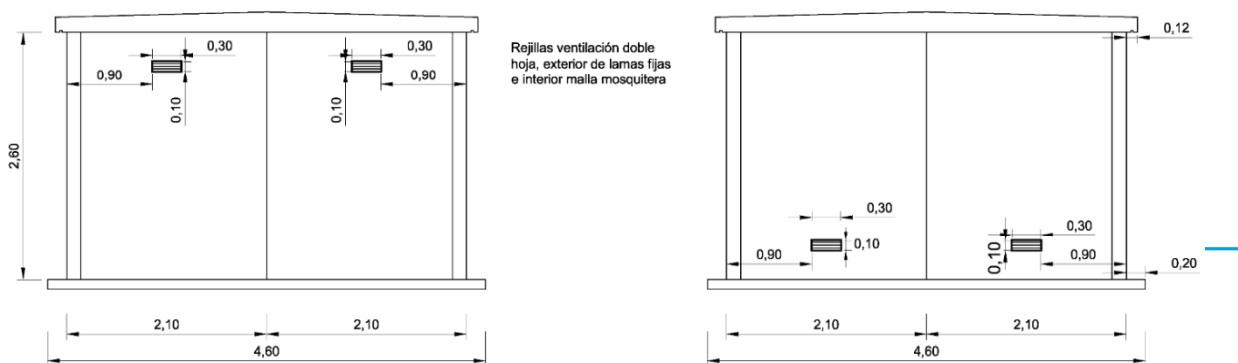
Alzados laterales con rejillas de ventilación doble hoja de una Estación de Telecontrol Tipo
